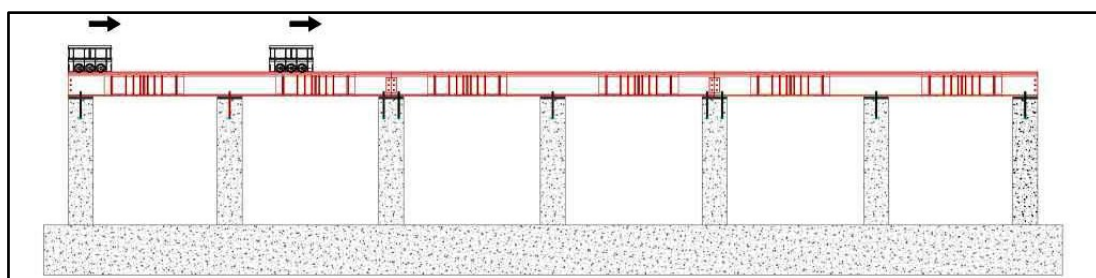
Corte transversal da viga de ripagem, pilares e “bogies”
